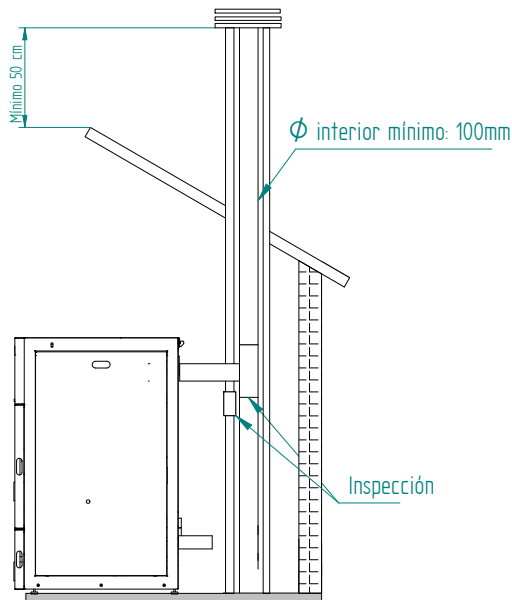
Vista lateral de la instalación con chimenea, con ejemplo del punto de inspección.
